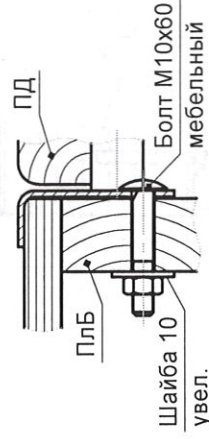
Крепление пандуса деревянного (ПД) и горки к площадкам башен (ПлБ)
